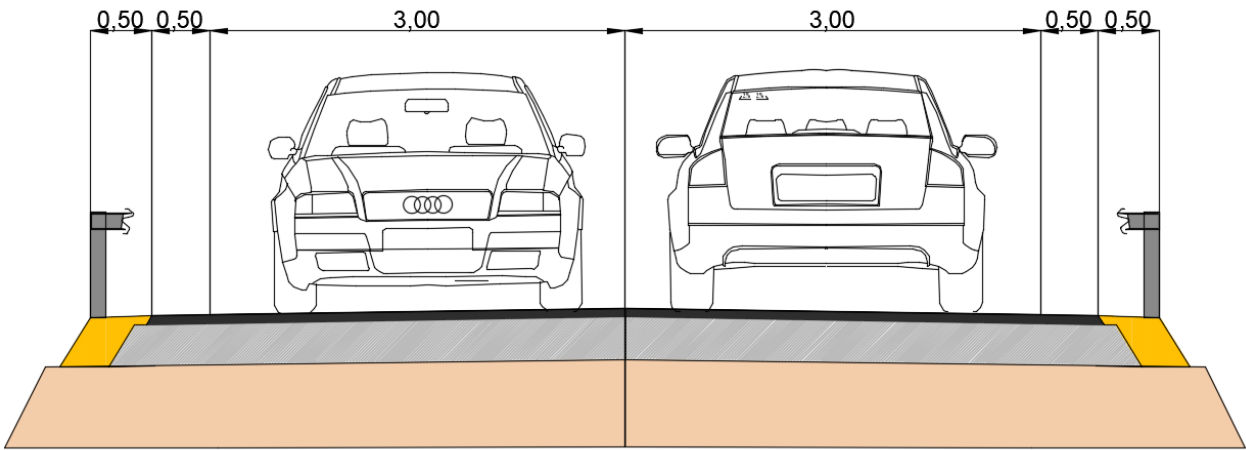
Sección transversal de la nueva calzada del tramo 1. (Fuente: Elaboración propia)
